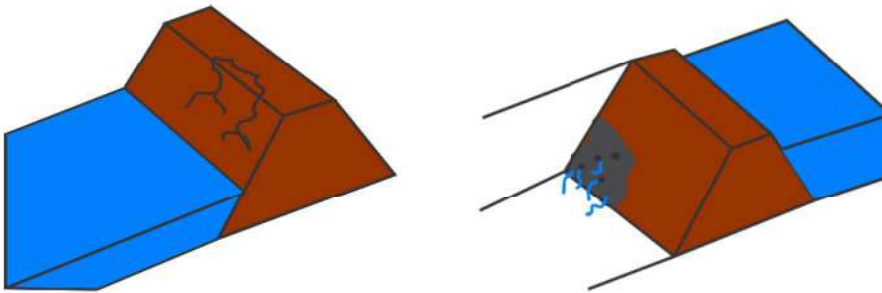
Ilustração de situações em que ocorrem rachaduras e vazamentos vindos da ombreira, respectivamente.
